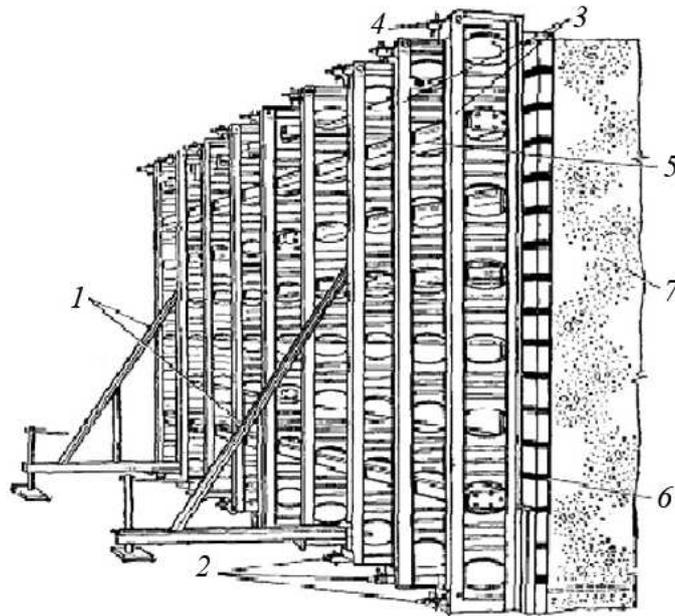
Крупнощитовая опалубка: 1 – подкосы с винтовыми домкратами; 2 – стяжные болты; 3 – вертикальные унифицированные несущие элементы; 4 – крепления стяжных болтов; 5 – горизонтальные унифицированные несущие элементы; 6 – опалубка щита; 7 – бетон
